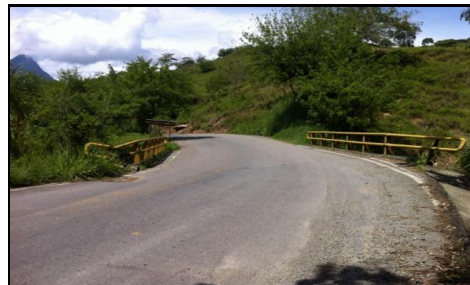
VISTA PANORÁMICA TRANSVERSAL
